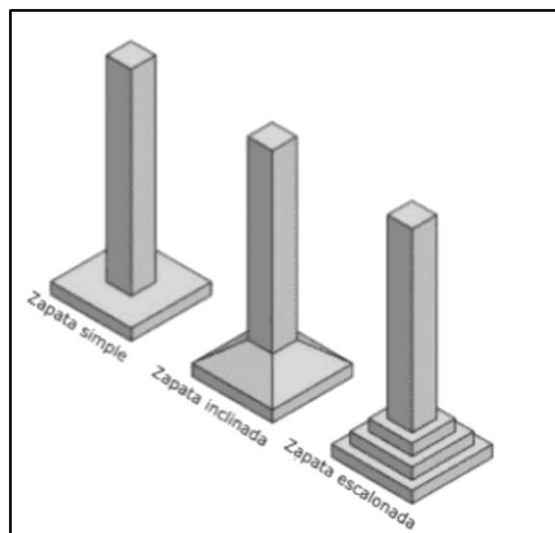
Zapatas aisladas. [Maldonado, 2018]
